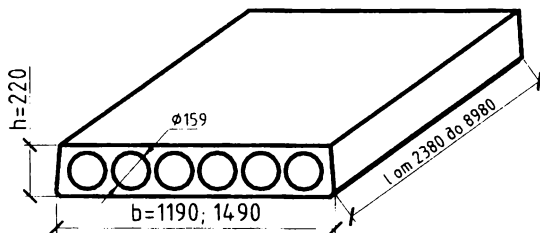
Общий вид многопустотной плиты с круглыми пустотами
